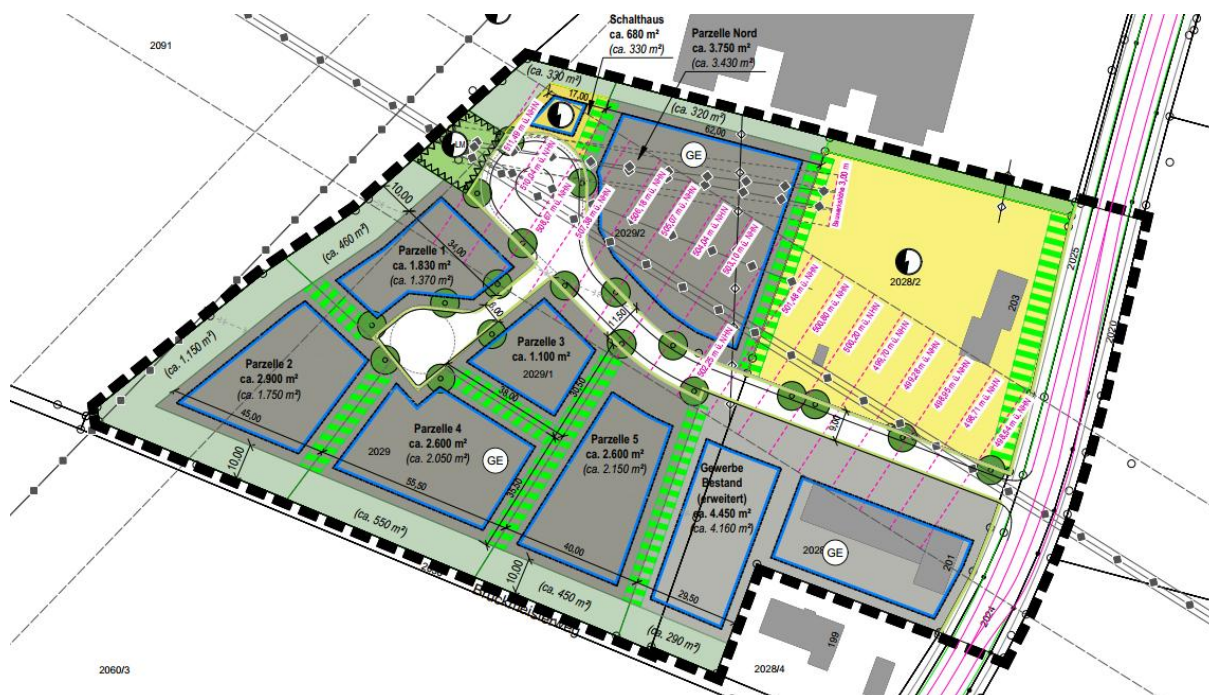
Städtebauliches Konzept zum Bebauungsplan Nr. 79 – ohne Maßstab
